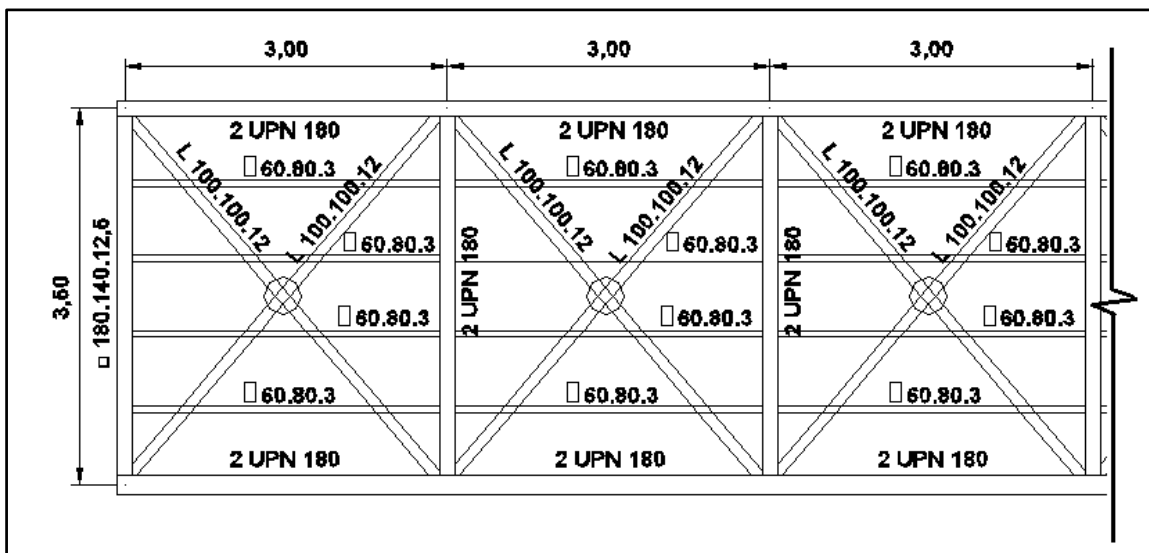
Planta inferior del tablero. Fuente: Documentación gráfica cortesía de Acciona.
